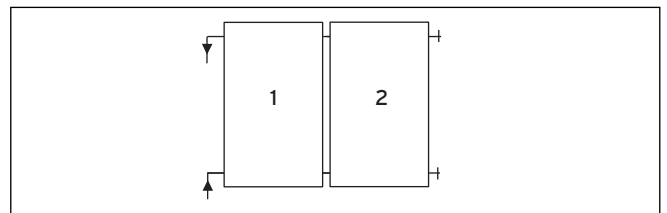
Collegamento al campo su un solo lato con 1 - 2 collettori piani VFK 135/2 VD
